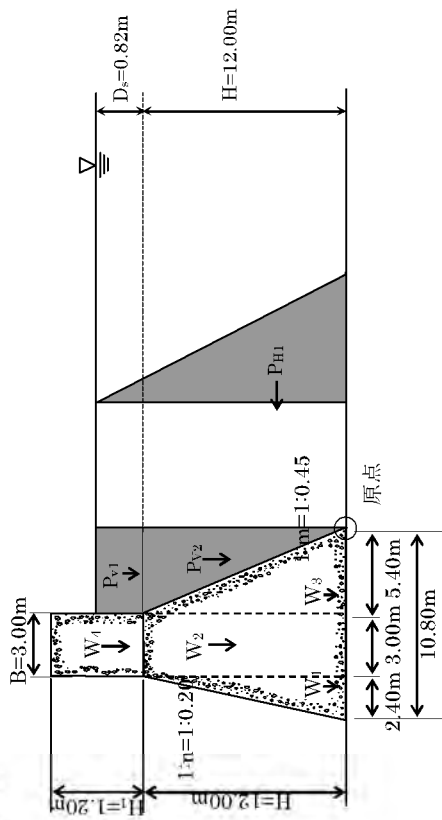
砂防堰堤に作用する力 (断面 (1) : 洪水時)
